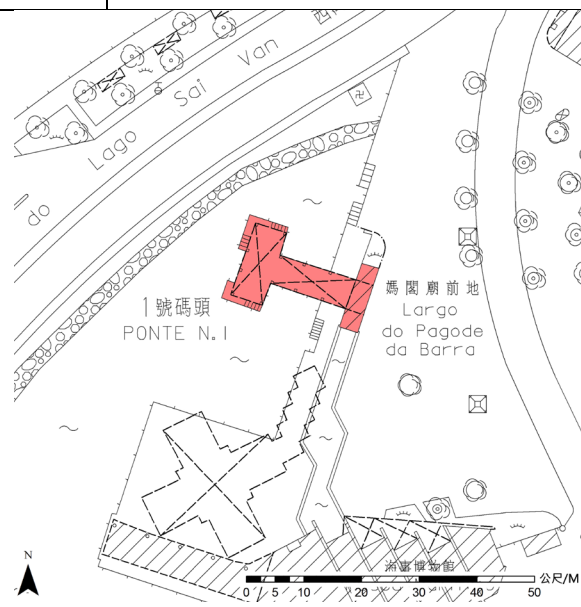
Planta de implantação do imóvel em vias de classificação
